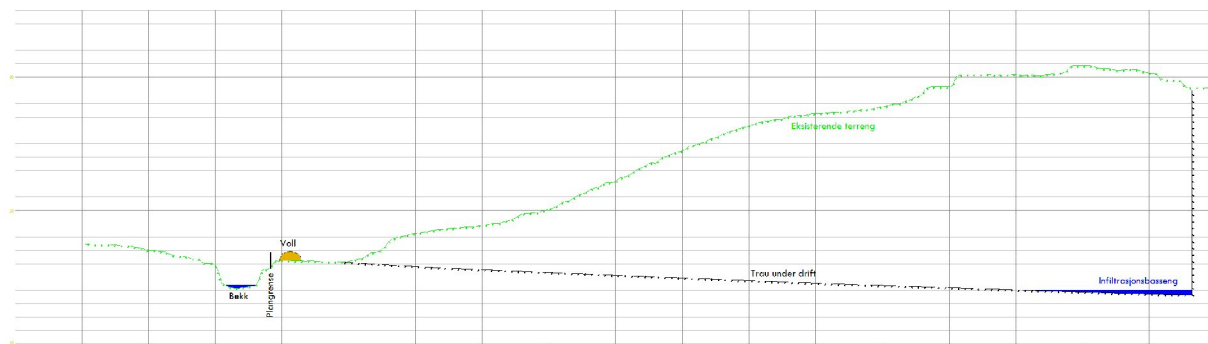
Avrenningsveier for overvann ovenfor planområdet
